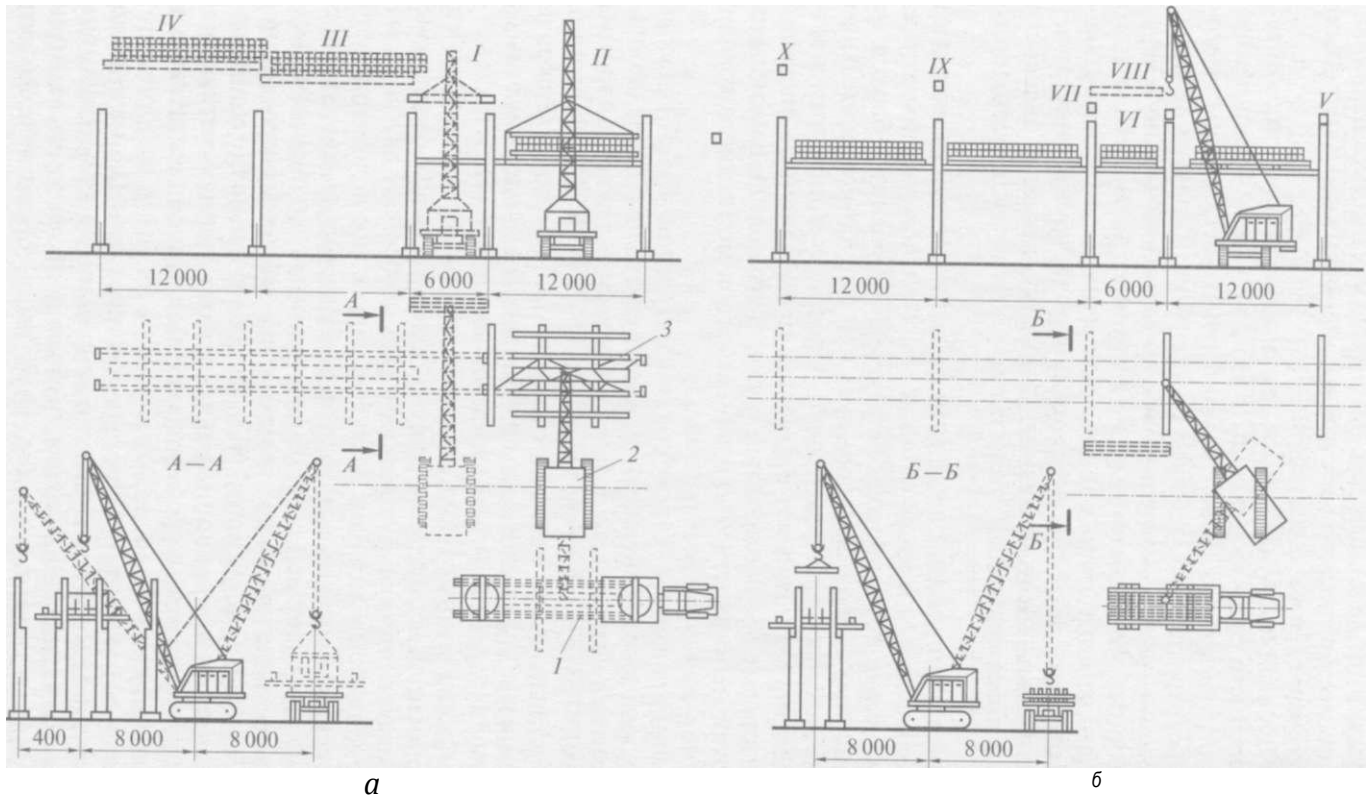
Схема монтажа комбинированных блоков железобетонной балочной двухъярусной эстакады:
